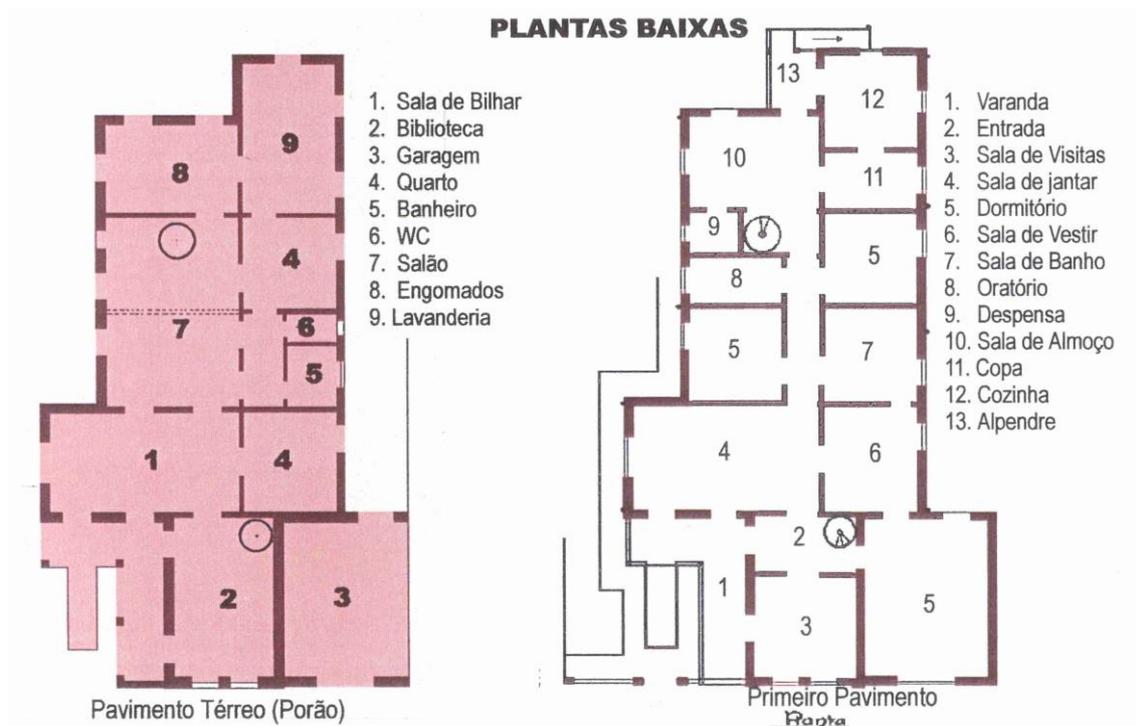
Palacete Orlando Lima: Plantas Baixas: térreo e primeiro pavimento.
